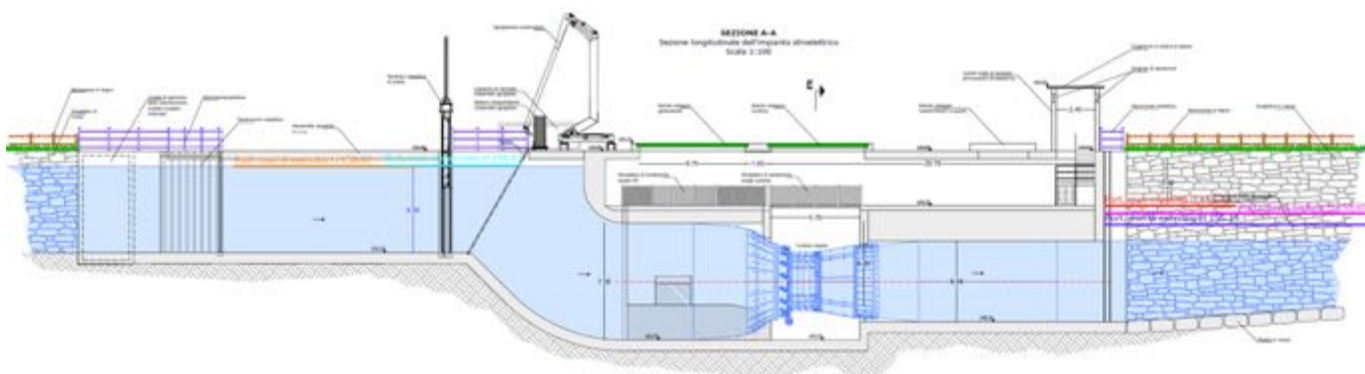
Sezione longitudinale turbina Kaplan "PIT"
